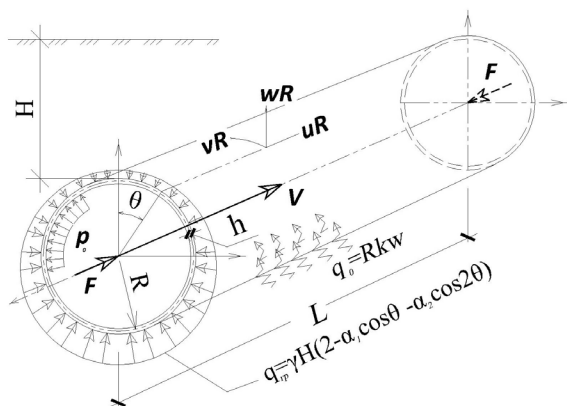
Расчётная схема трубопровода (L – оболочка длины, R – радиус, h – толщина стенки, p_0 – постоянное внутренне рабочее давление, F – продольная сжимающая сила, q_0 – реакция упругого отпора грунта, $q_{rp} = H\gamma$ – давление грунта)
